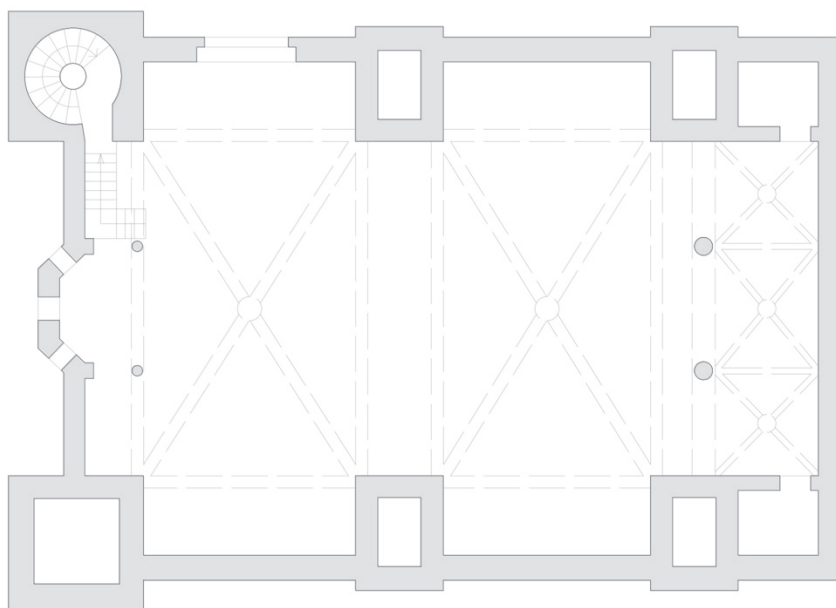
Planta de la iglesia de San Félix en Torralba de Ribota E 1/250
